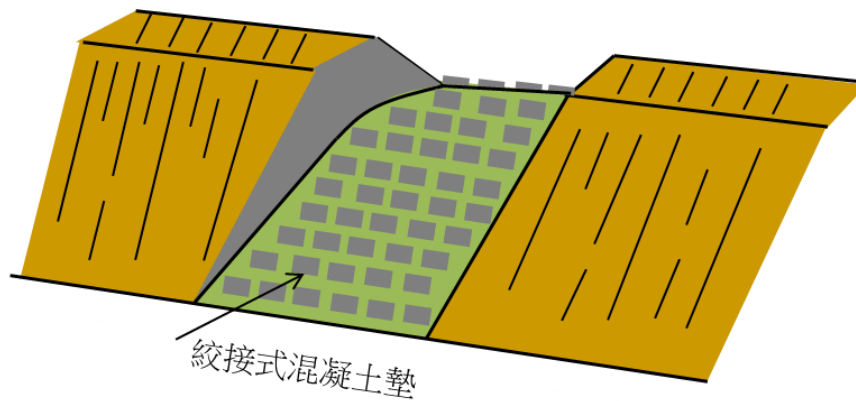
絞接式混凝土墊緊急臨時溢洪道示意圖
